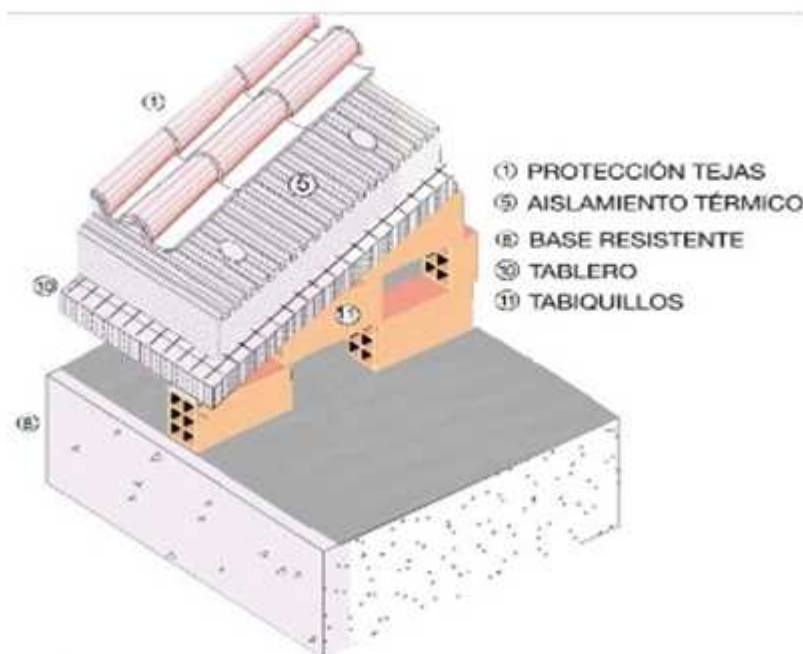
Aislamiento por el exterior de poliestireno expandido. Fuente GREEV
